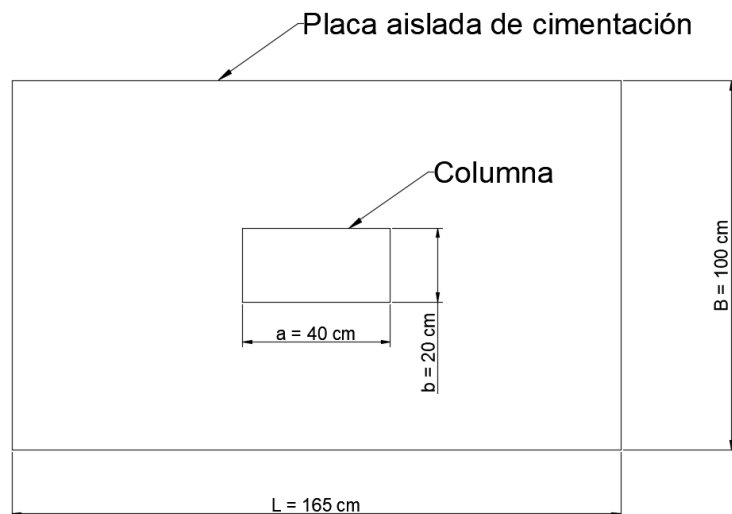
Vista en planta de la placa aislada de cimentación con la columna.
